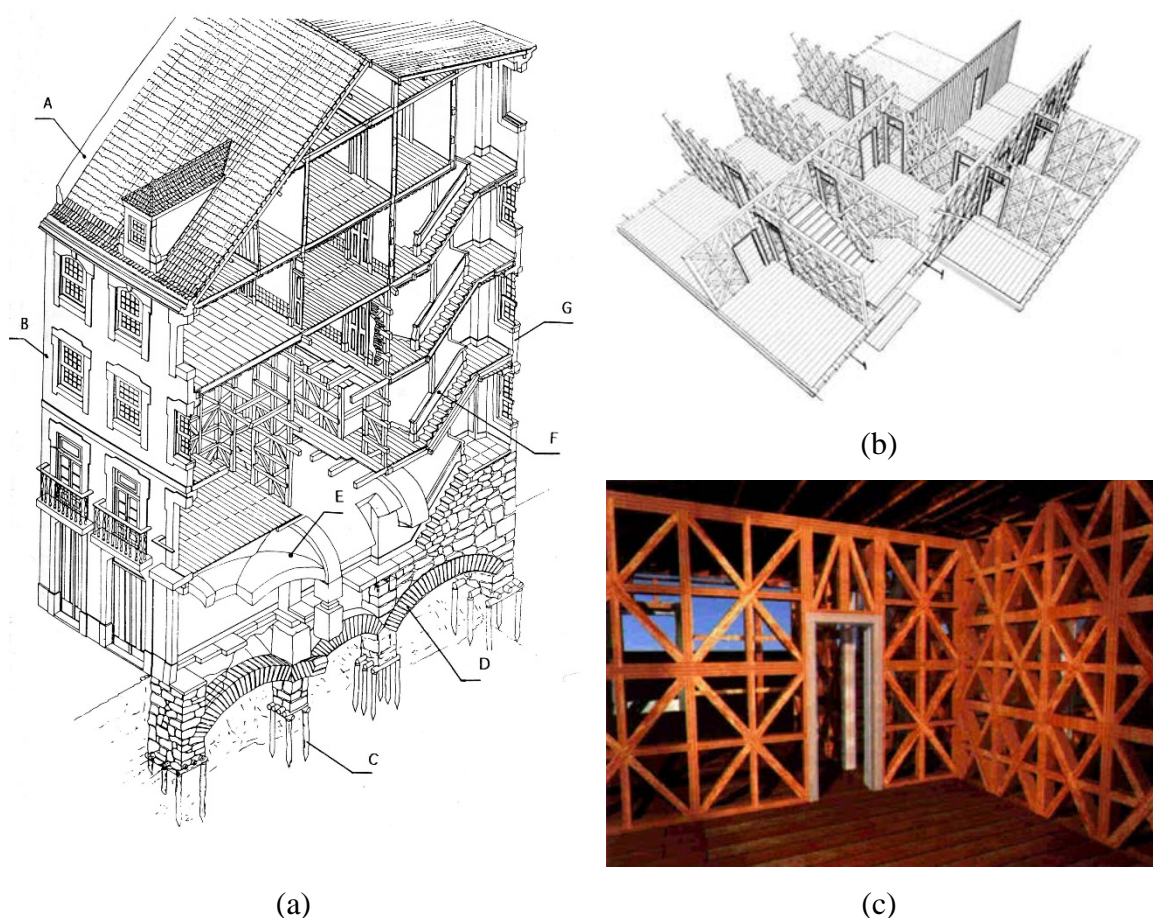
Pormenores construtivos: (a) perspetiva em corte da construção Pombalina: A – paredes corta-fogo; B – fachadas em paredes grossas de alvenaria de pedra; C – sistema de estacas; D – arcos em pedra; E – abóbadas em pedra no primeiro piso; F – parede que dificultava a ascensão rápida dos fumos pelas escadas; G – escadas colocadas junto dos logradouros para iluminação; (b) perspetiva de um piso formado por gaiolas pombalinas; e (c) imagem virtual do interior de um edifício [1].
